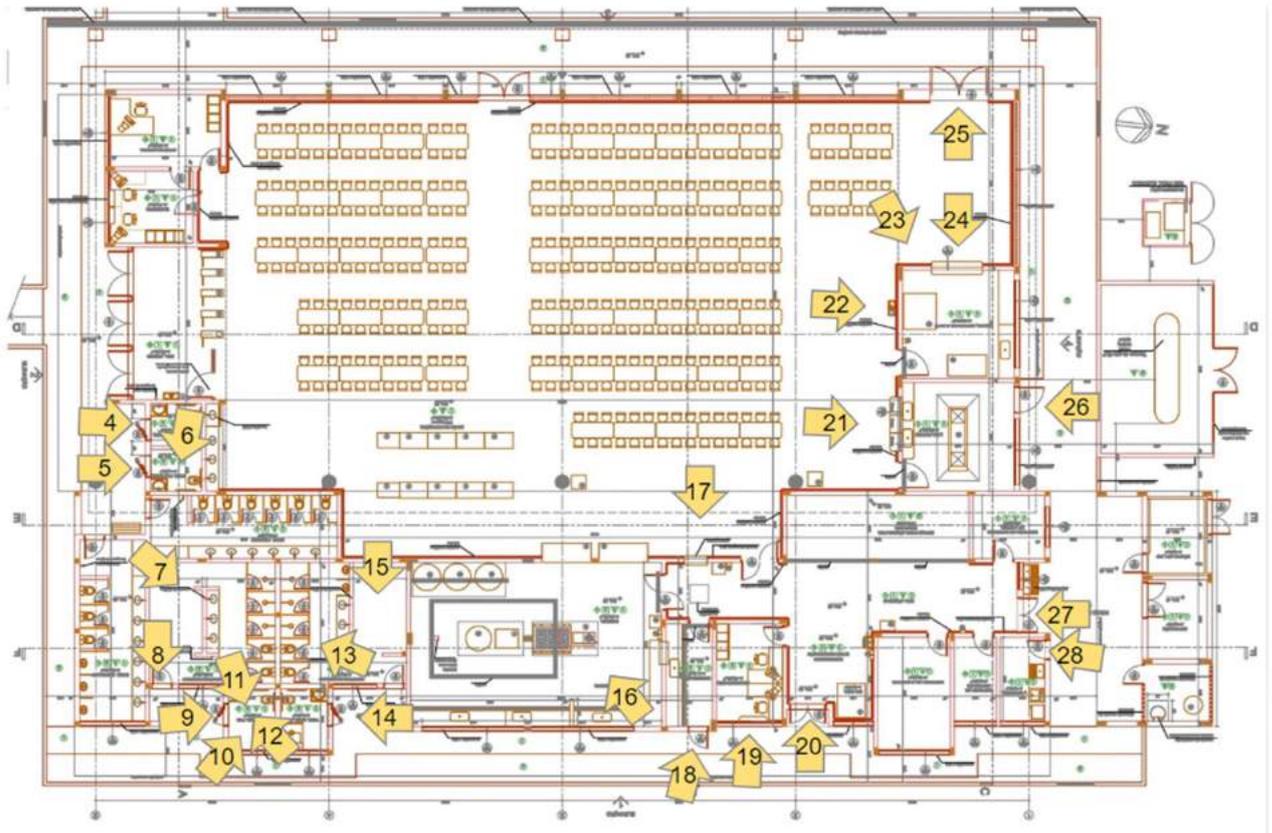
Planta do RS – Montagem Autor: Dutra, P. 2020
